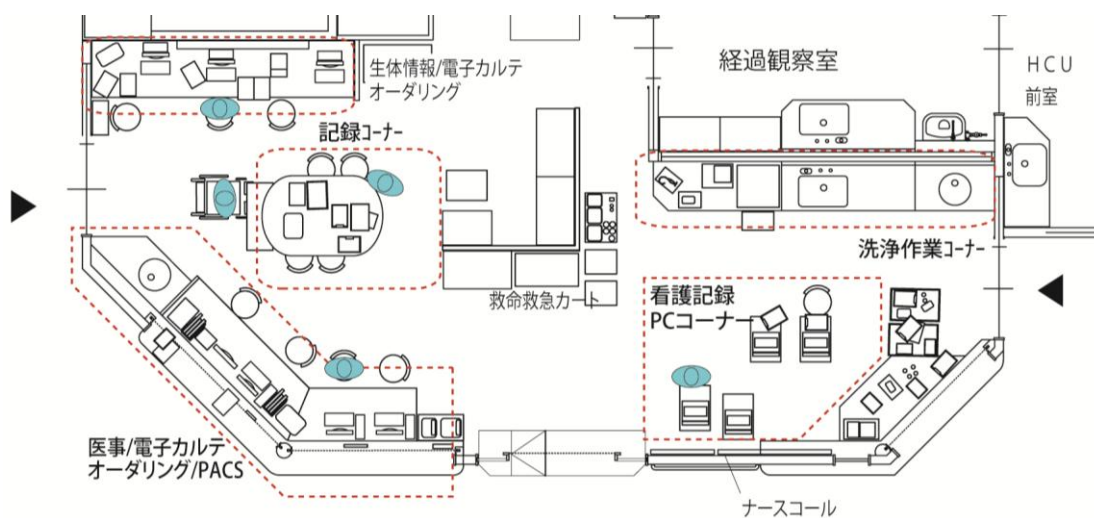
病棟の平面図 (Y 病院 : 整形外科)
